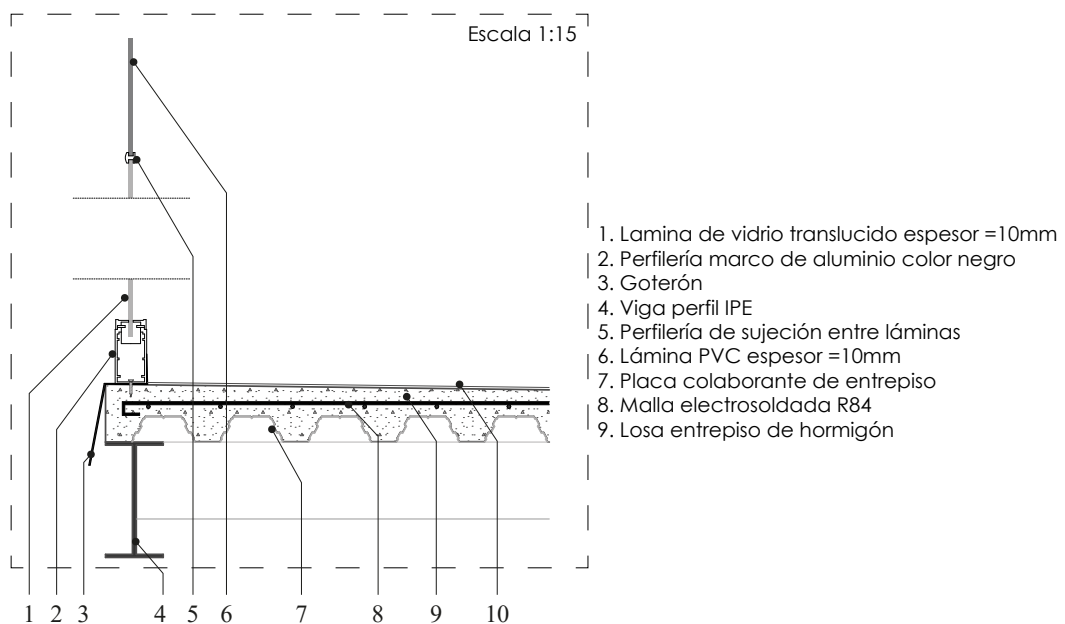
Detalle constructivo losa entrepiso y ventanal de vidrio y PVC
